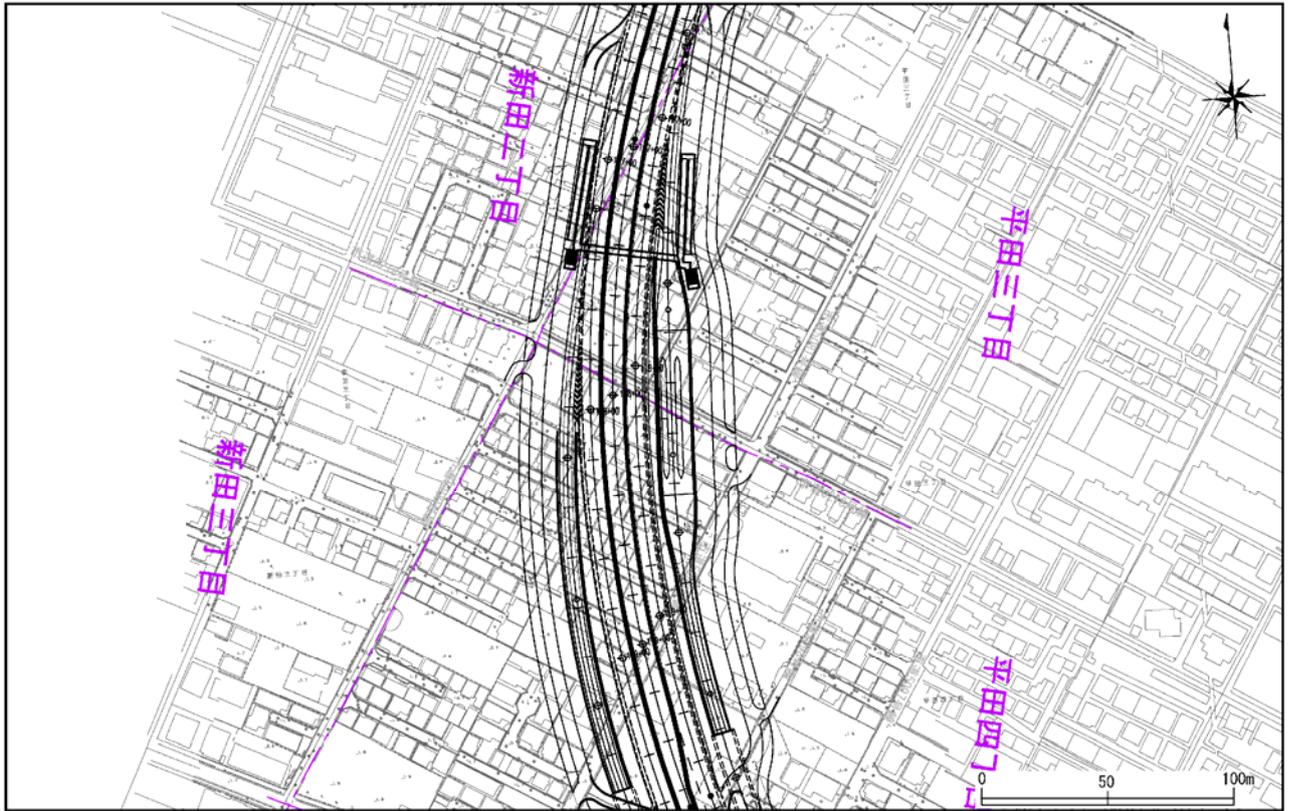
(21) 特殊部予測平面图 (市川南 IC)
